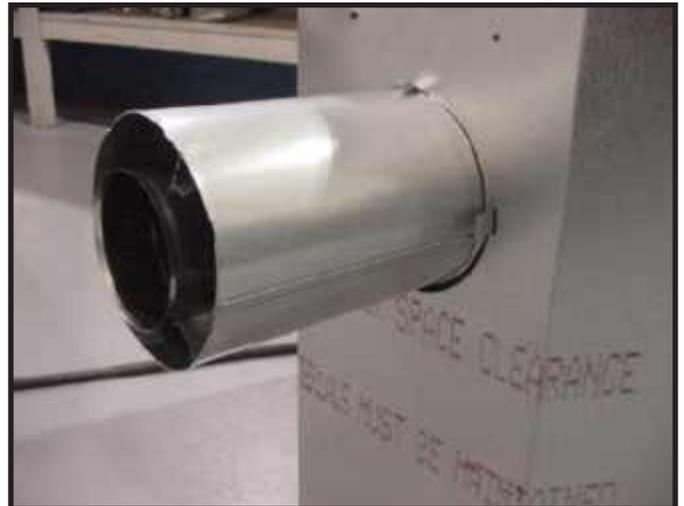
Posez la première section du conduit d'évacuation (elle se met en place en provoquant un clic). Glissez le joint du conduit d'évacuation sur cette section du conduit, puis verticalement contre l'appareil. Vissez le joint du conduit d'évacuation sur l'appareil avec deux vis autotaraudeuses présentes dans le sac du manuel. Remarque : Le joint du conduit d'évacuation se trouve dans le sac du manuel.
